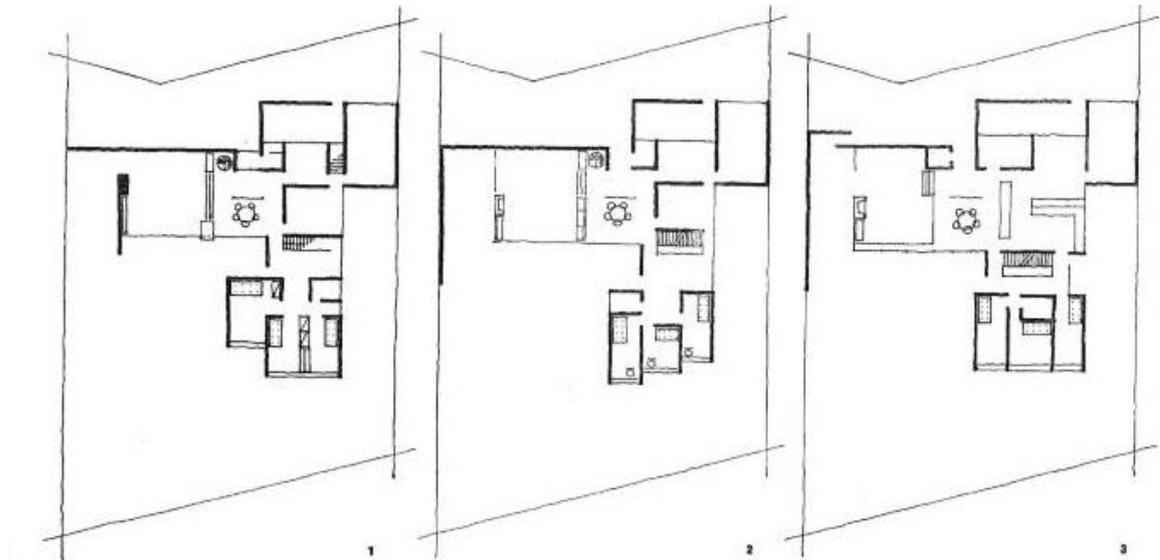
Grundrissvorschläge des Architekten
